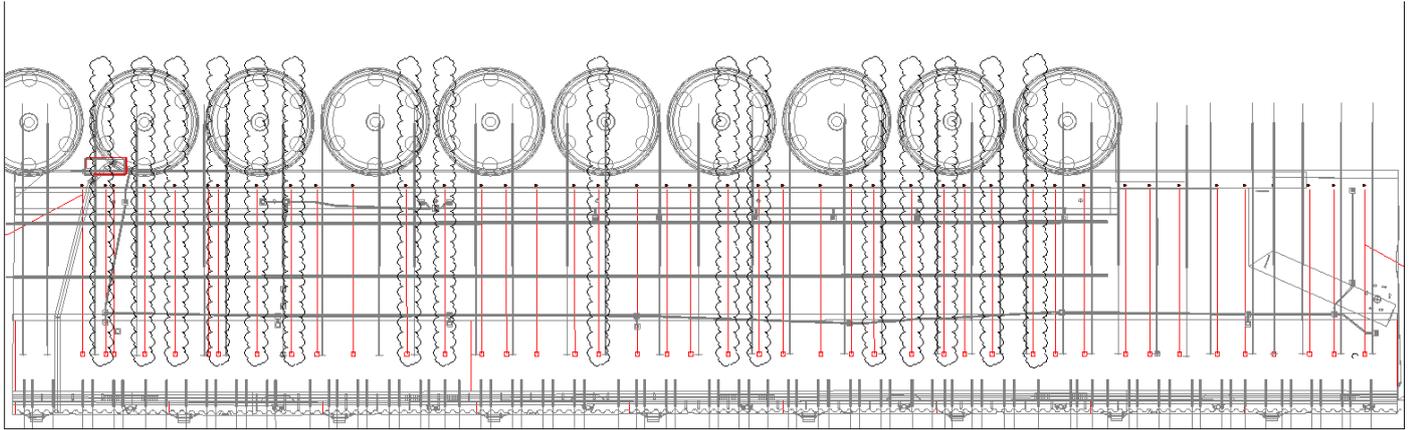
Bunge Nord – Pianta dei 16 micropali di progetto collimanti con le fondazioni
